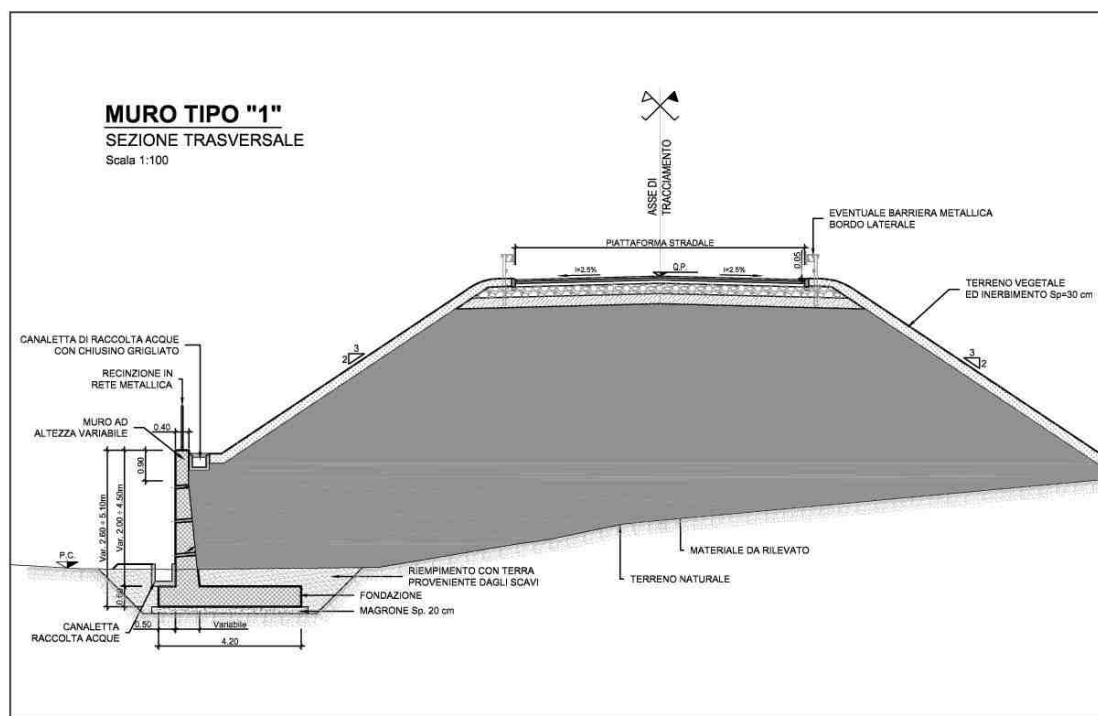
NV93: Muro di sottoscarpa MU20B- Sezione. TIPO 1
